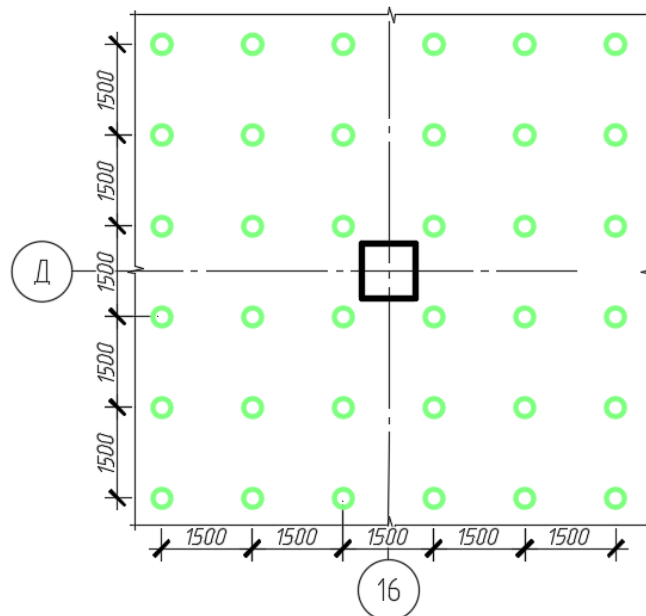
Схема расположения свай под фрагмент плитного фундамента
